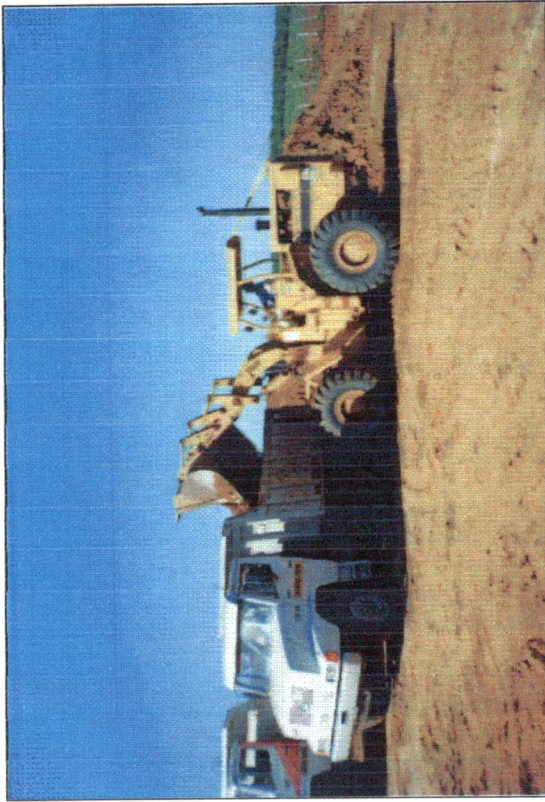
Exploração da Jazida Terrosa JT-4.
